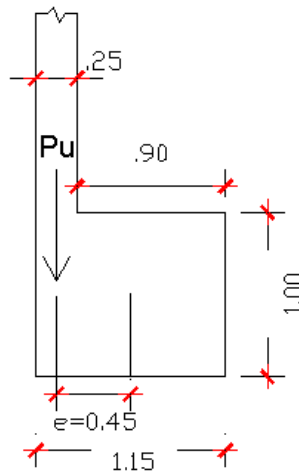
Corte en elevación de la cimentación Zapata Z-05.
